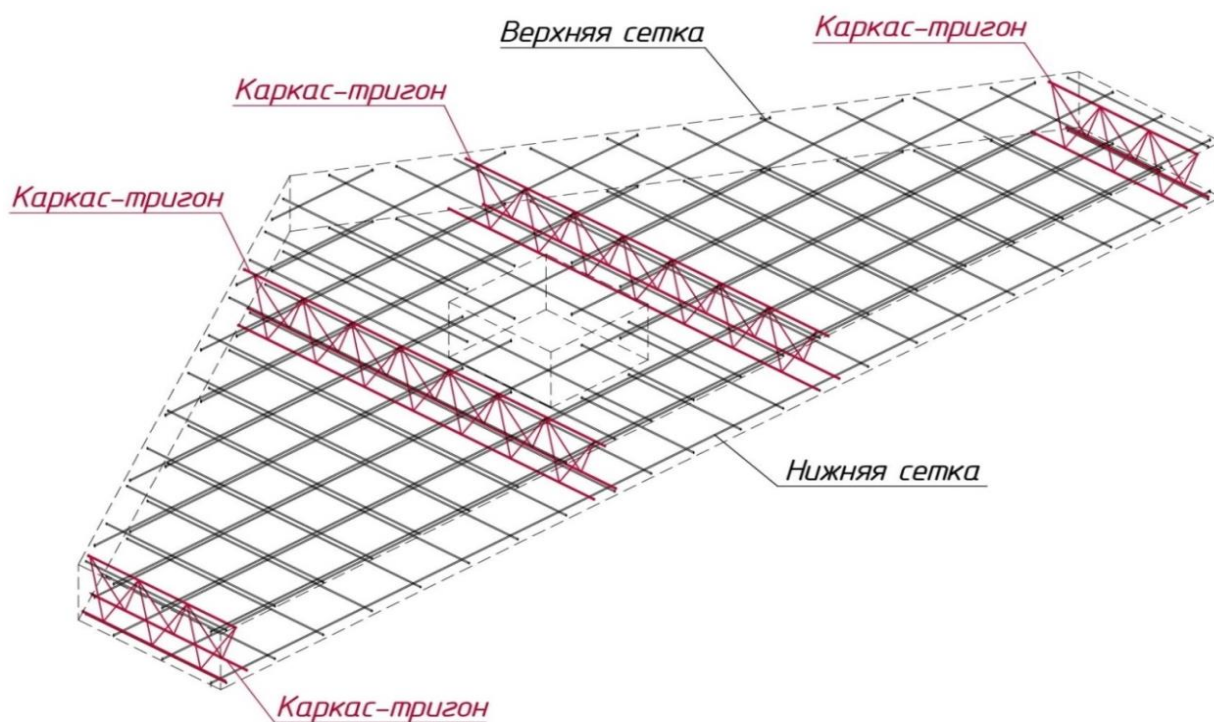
Схема армирования стеновых панелей фронтона каркасами-тригонами
